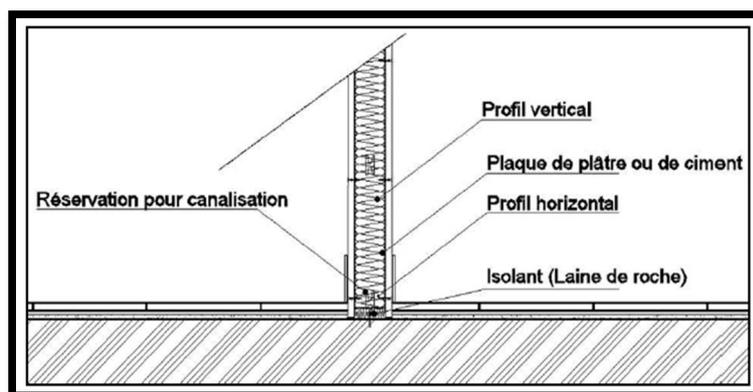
Détail de fixation de plaque au plâtre ou de ciment
